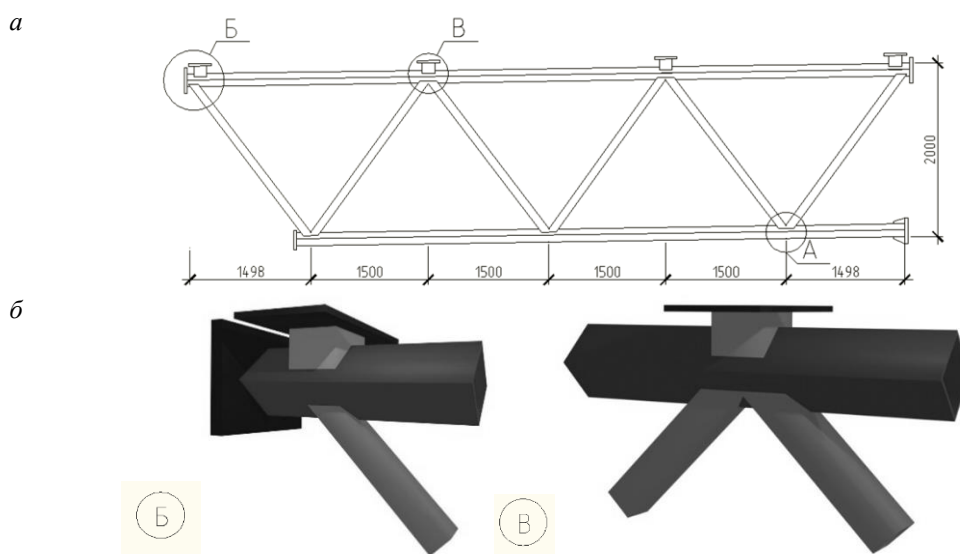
Оптимальная конструкция стропильной трубчатой фермы (а) с бесфасоночными узлами (б)
